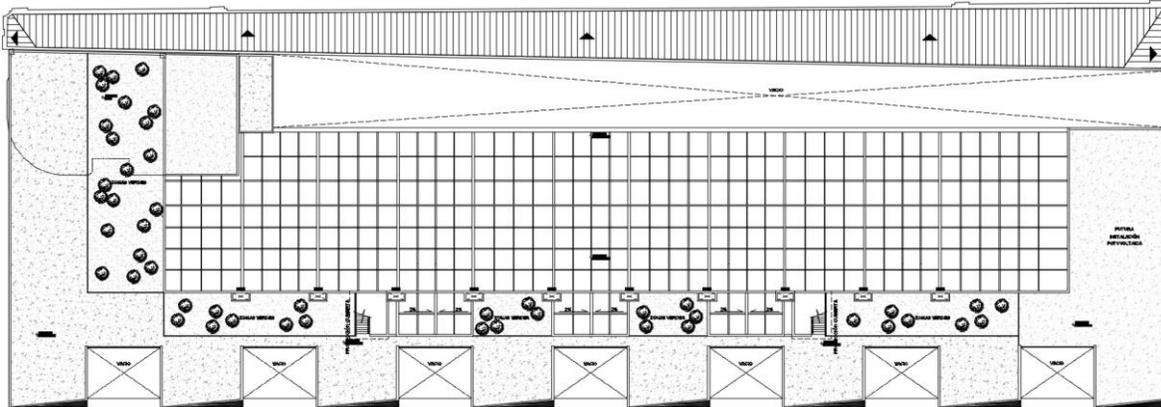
Planta primer piso – EDIFICIO CREATIVO
